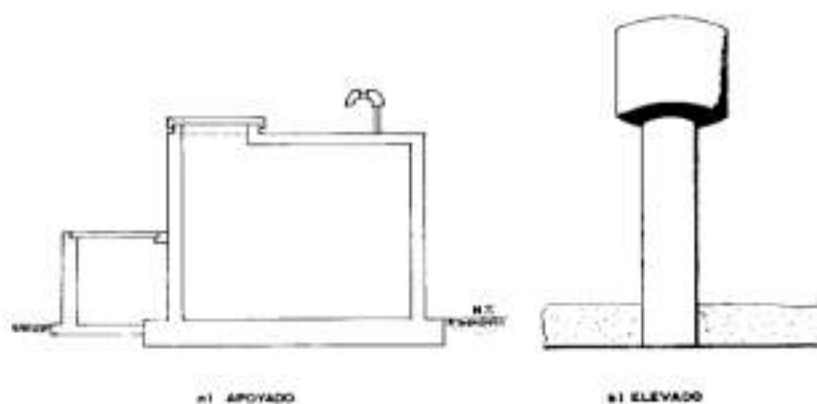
Tipos De Reservorio: Apoyado Y Elevado
